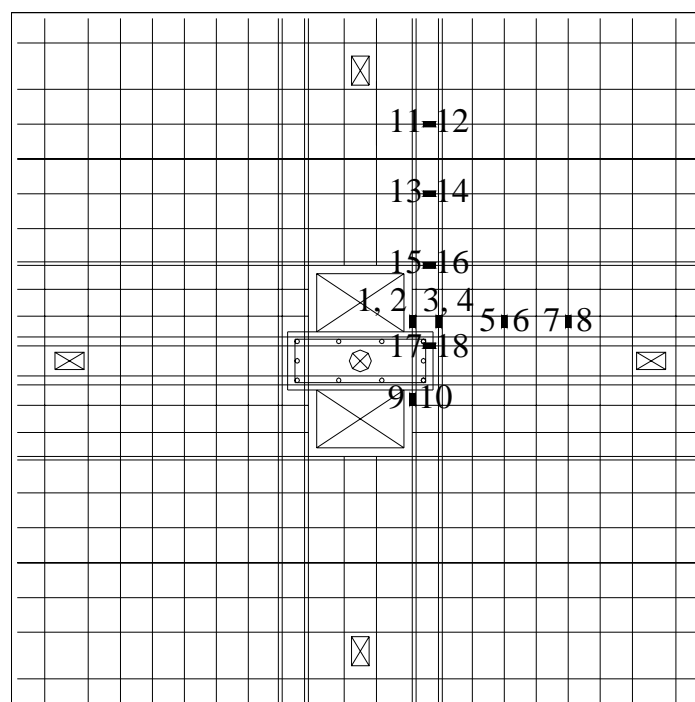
Posicionamento dos EERs no aço para as lajes L19 (mm)
